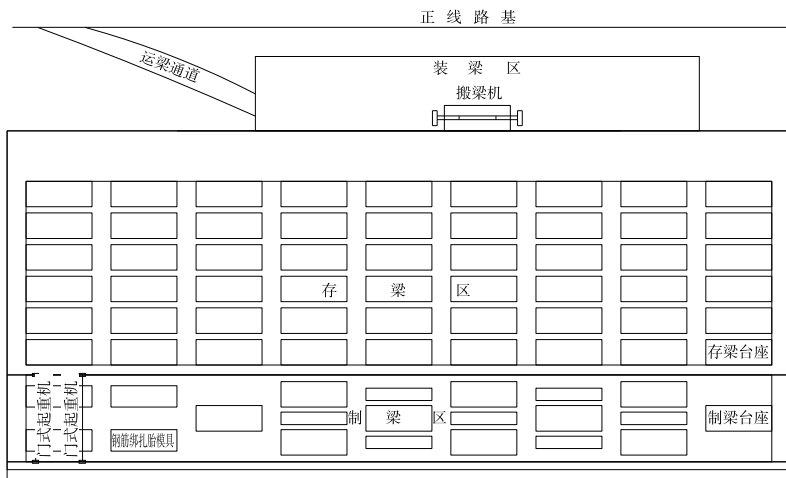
搬梁机搬梁、运梁车经运梁通道出梁箱梁预制场平面布置图
